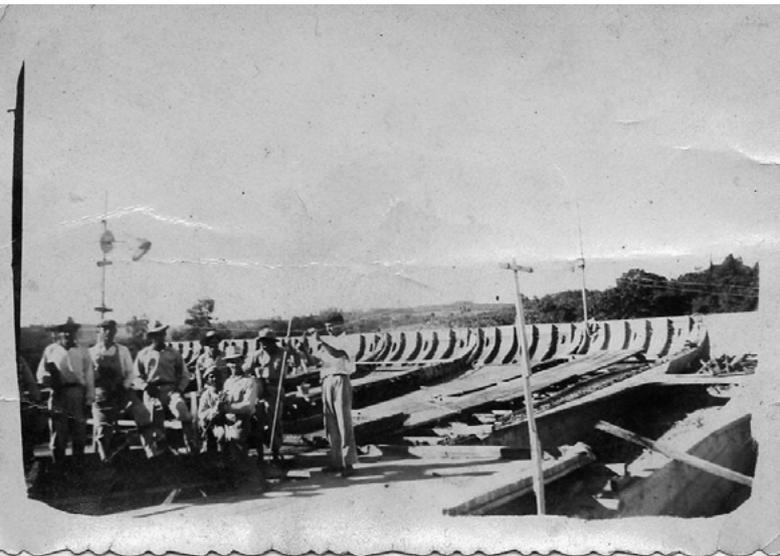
Equipo de construcción, costillas estructurales del techo.
